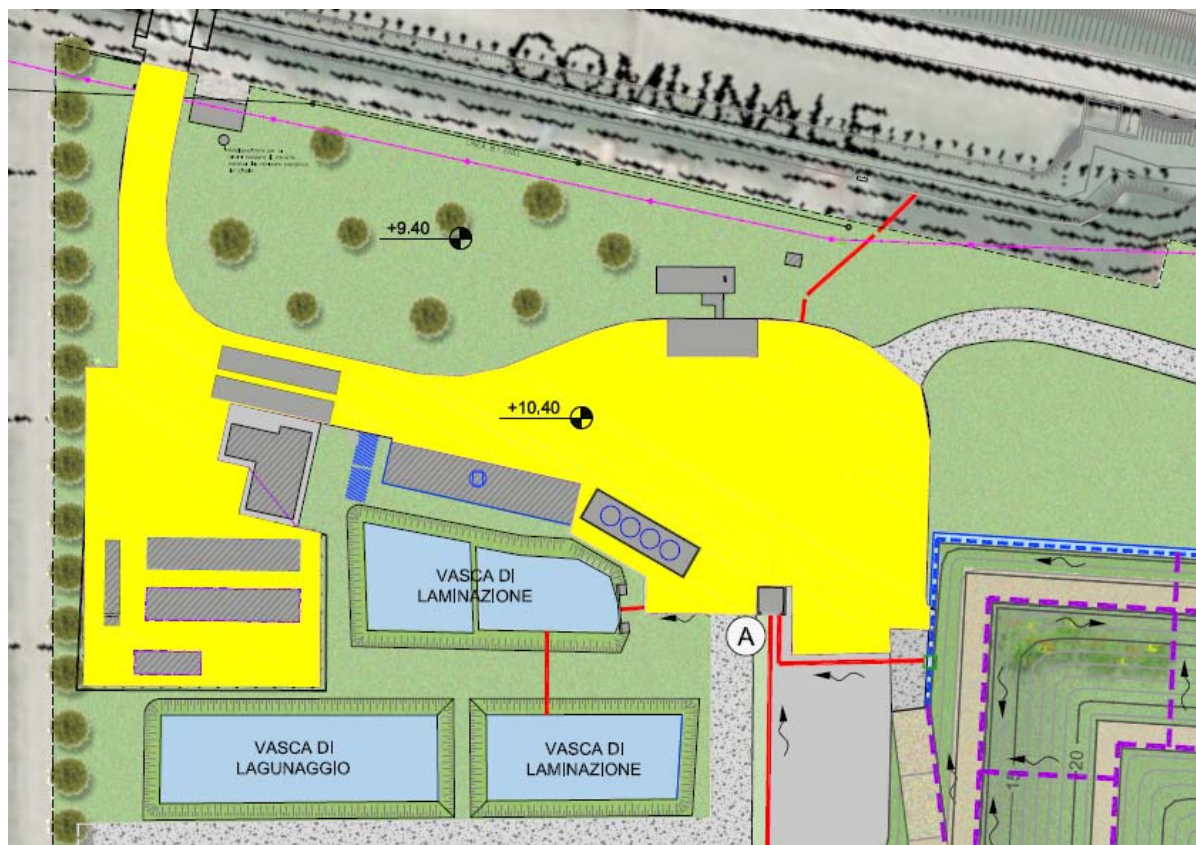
Planimetria con indicazione dell'area di raccolta delle acque di prima pioggia
